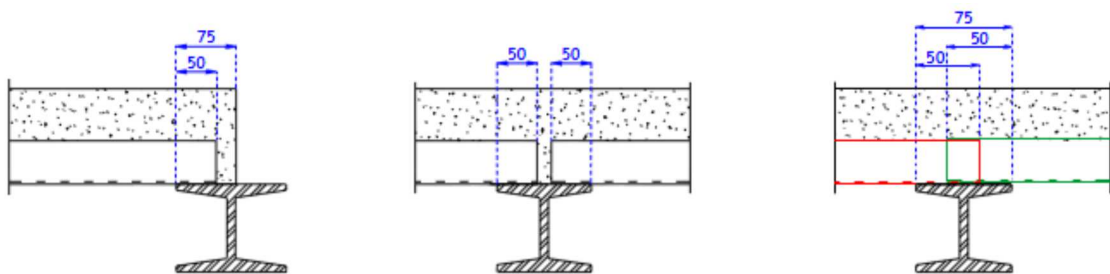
Distâncias mínimas [mm] de apoio da chapa em vigas metálicas [19]
